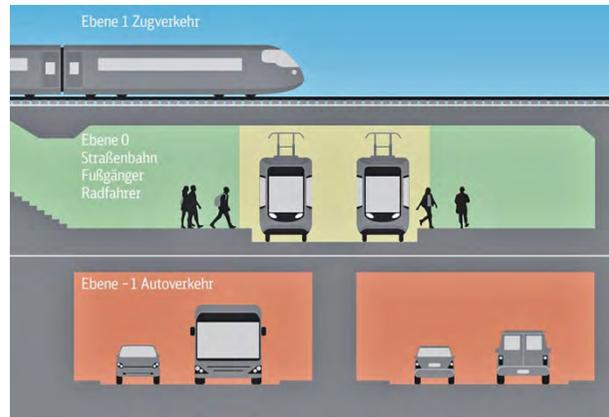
Bahnüberführung Ernst-Reuter-Allee (Schnitt)
